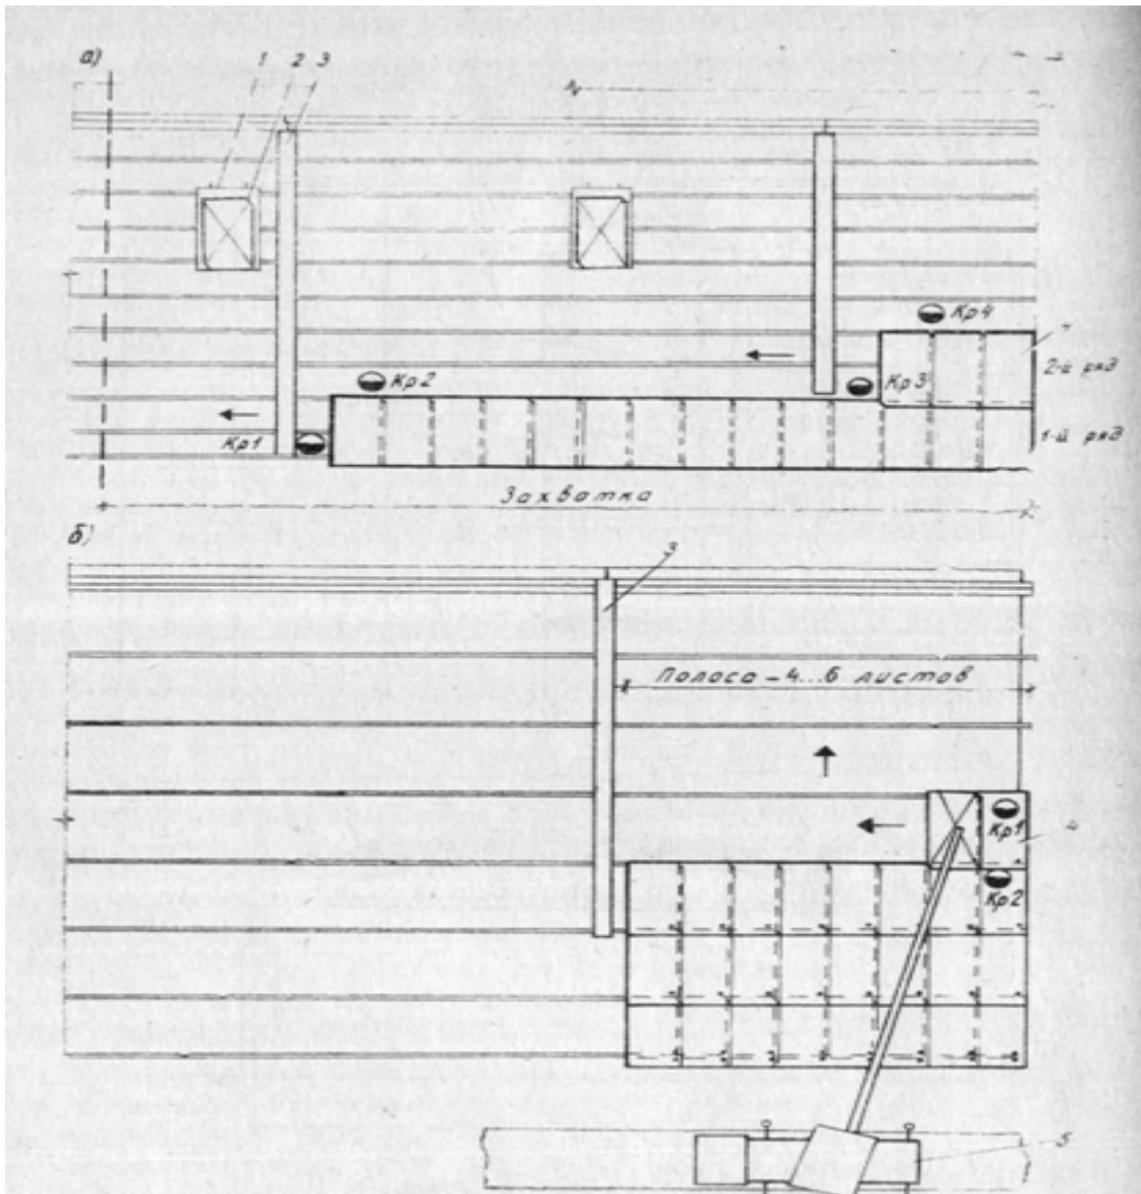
Организация работ при устройстве кровельного покрытия из асбестоцементных волнистых листов:
